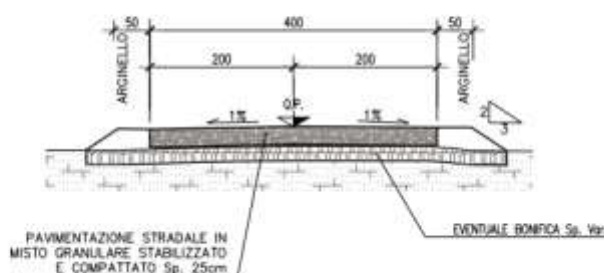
Sezione tipo complanare 4,0 m in rilevato
